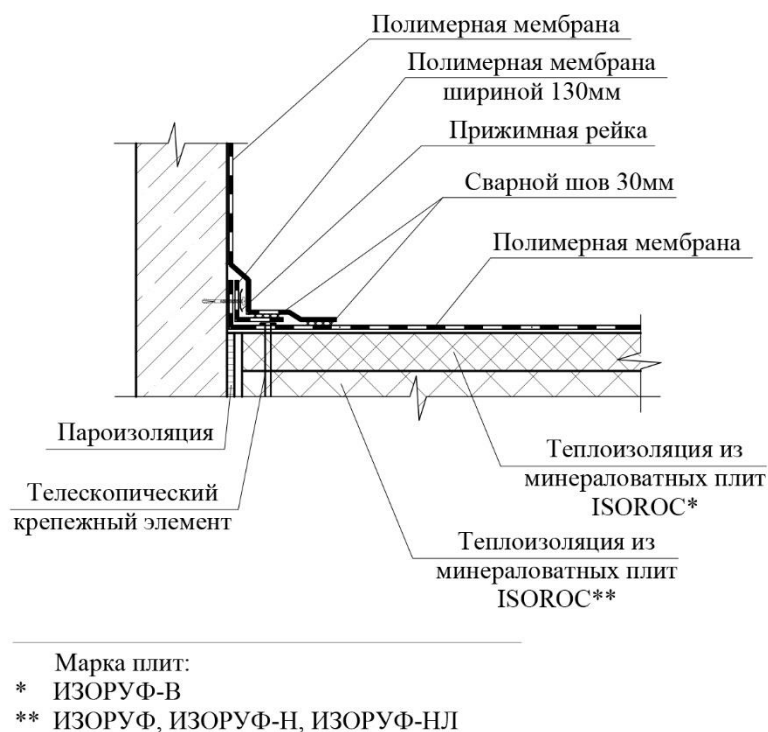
Раскладка кровельного гидроизоляционного материала на переходном бортике при однослойной укладке (устройство «скрытого» кармана).
